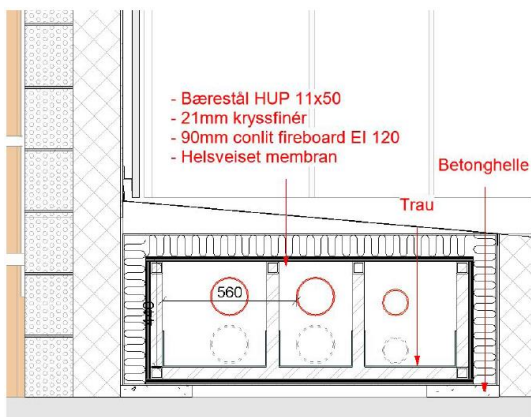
Detaljtegning av teknisk kasse rundt helipad.
